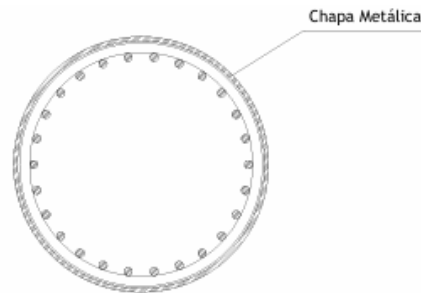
Pilar circular encamisado com chapas metálicas (17).
